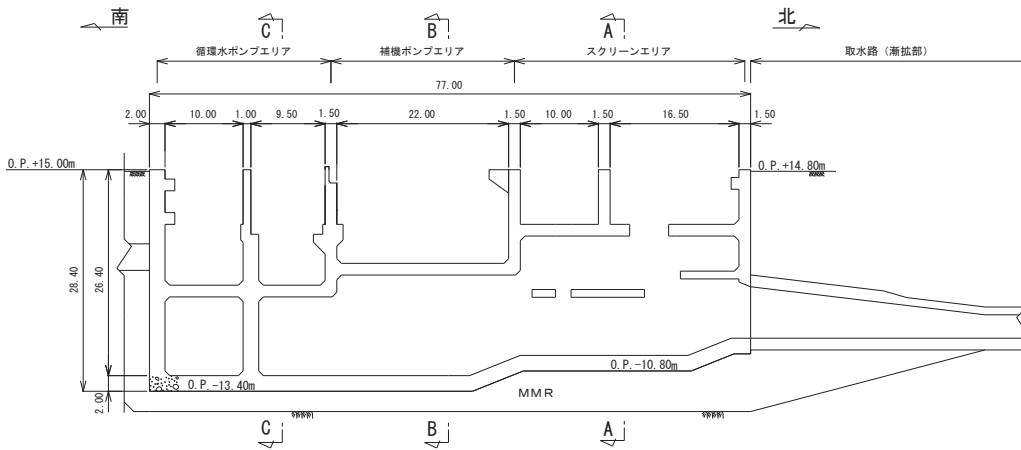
(2) 海水ポンプ室 概要図 (断面図)
